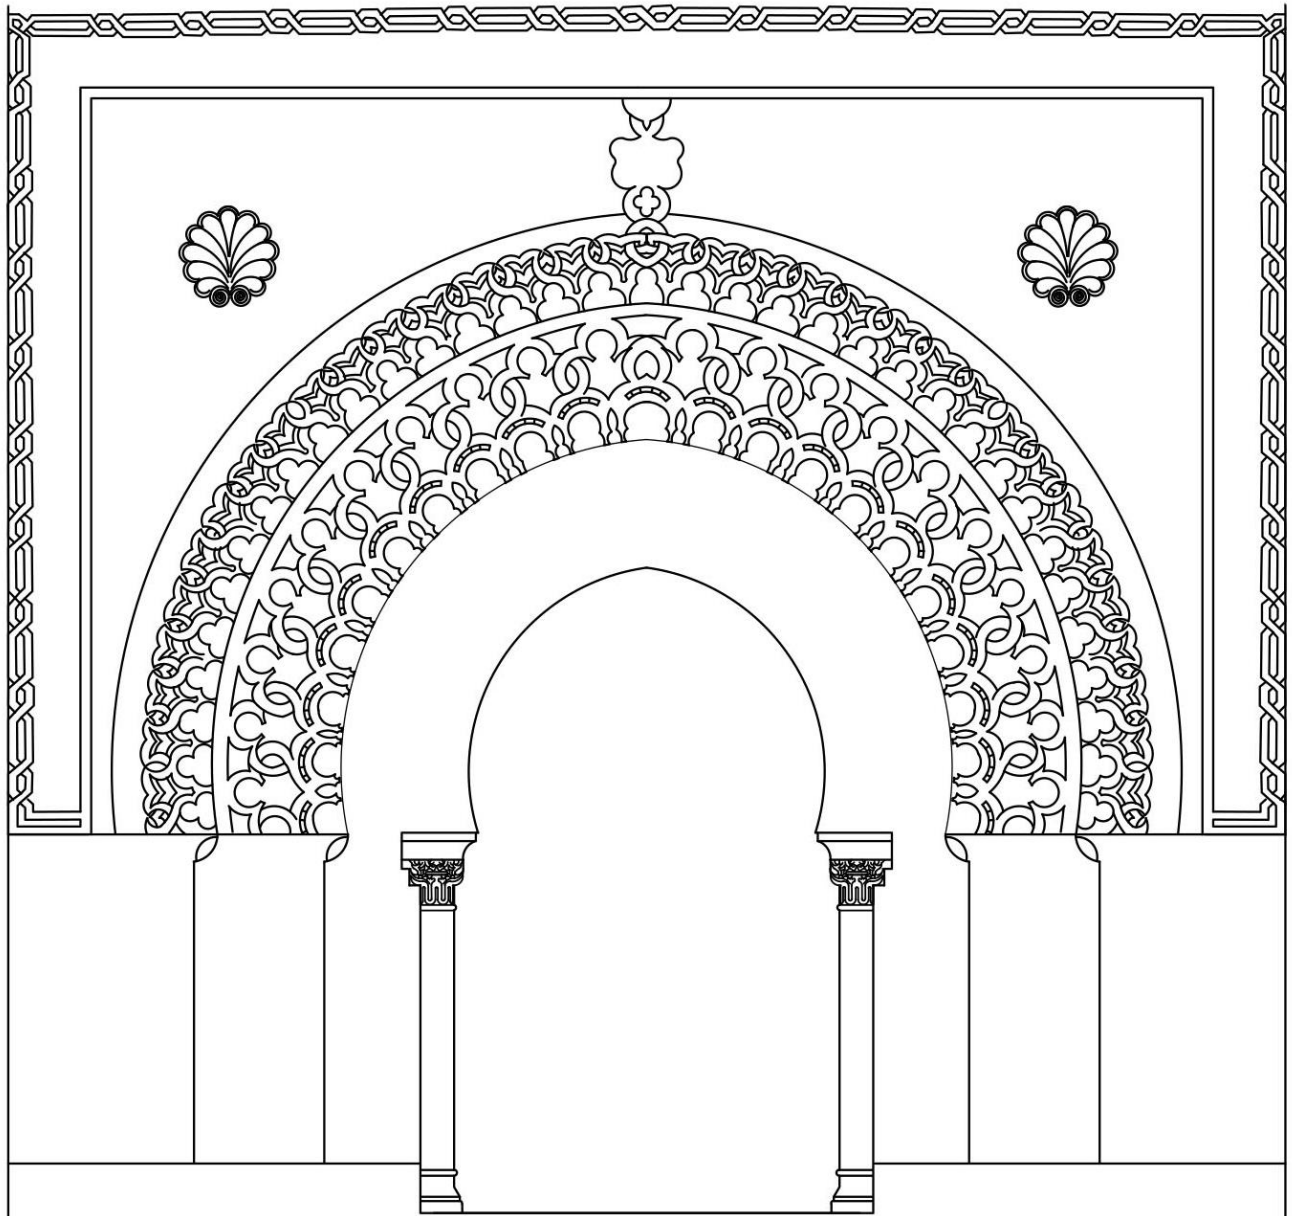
SUBDIVISION DE LA FAÇADE PRINCIPALE DU MINARET D'EL MANSOURAH
